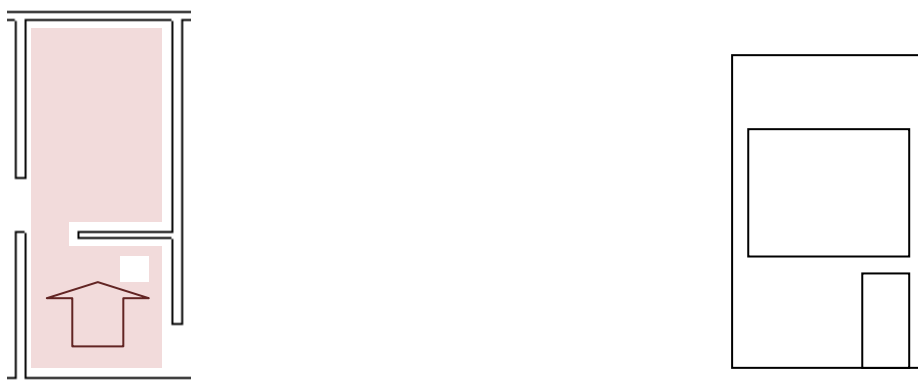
Módulo Edificações. Planta baixa e elevação esquemática da parede 07.
